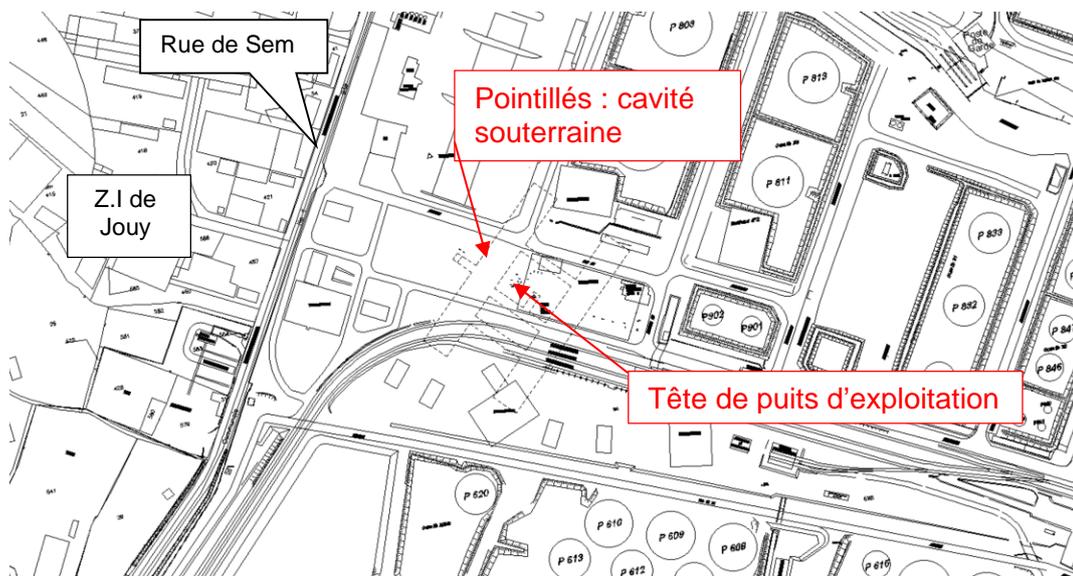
Plan d'implantation des installations de stockage souterrain de propane dans la raffinerie
